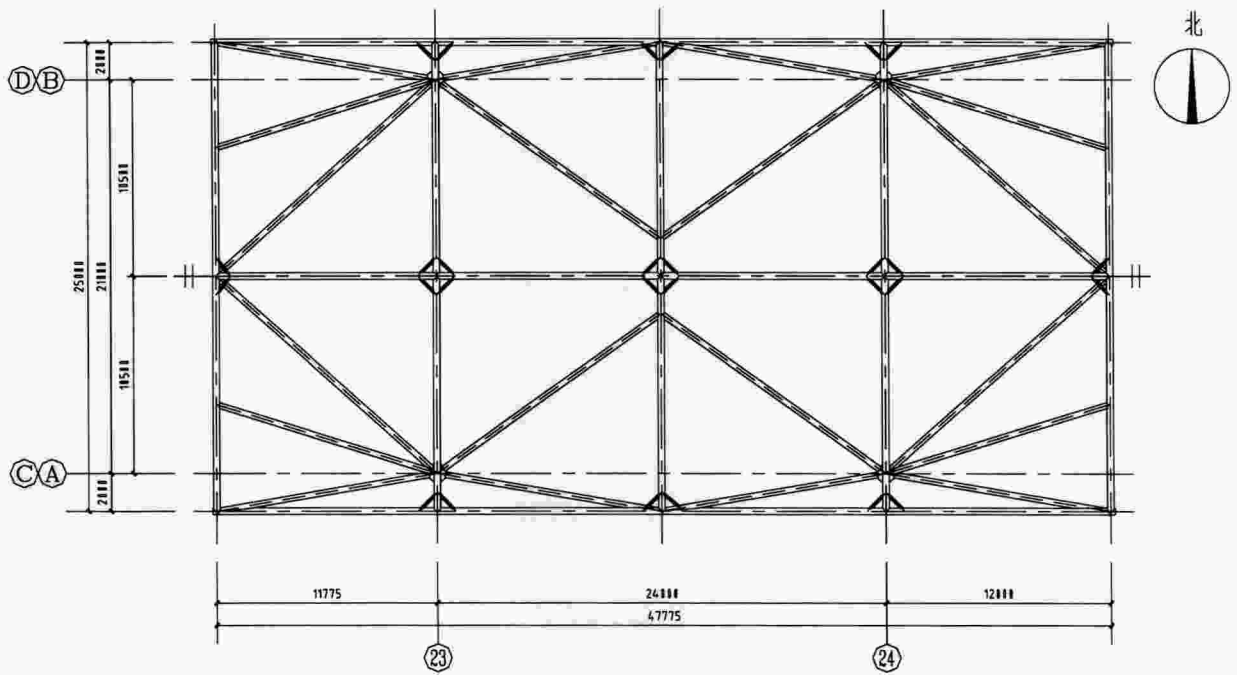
标准单体 C 结构平面布置示意图(单位: mm)
